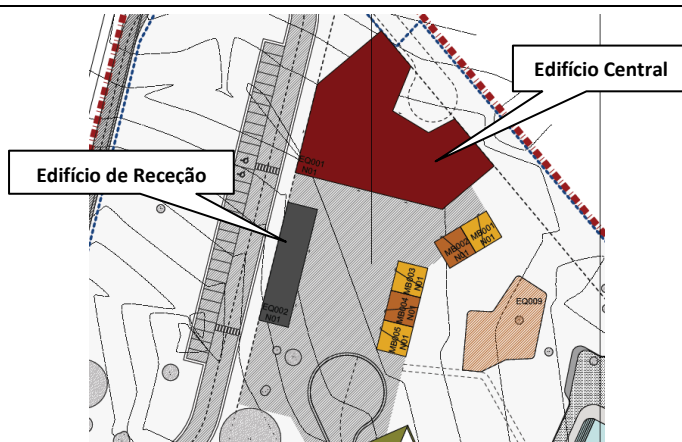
Edifício Central e Edifício de Recepção (pormenor da planta de projeto, s/escala)
